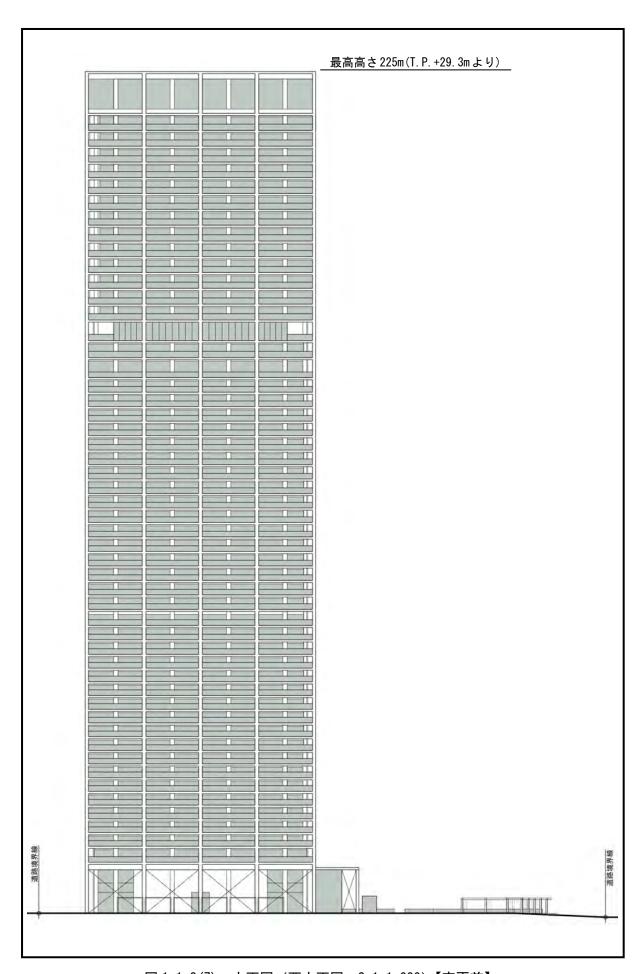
(7) 立面図 (西立面図 S=1:1,000) 【変更前】
